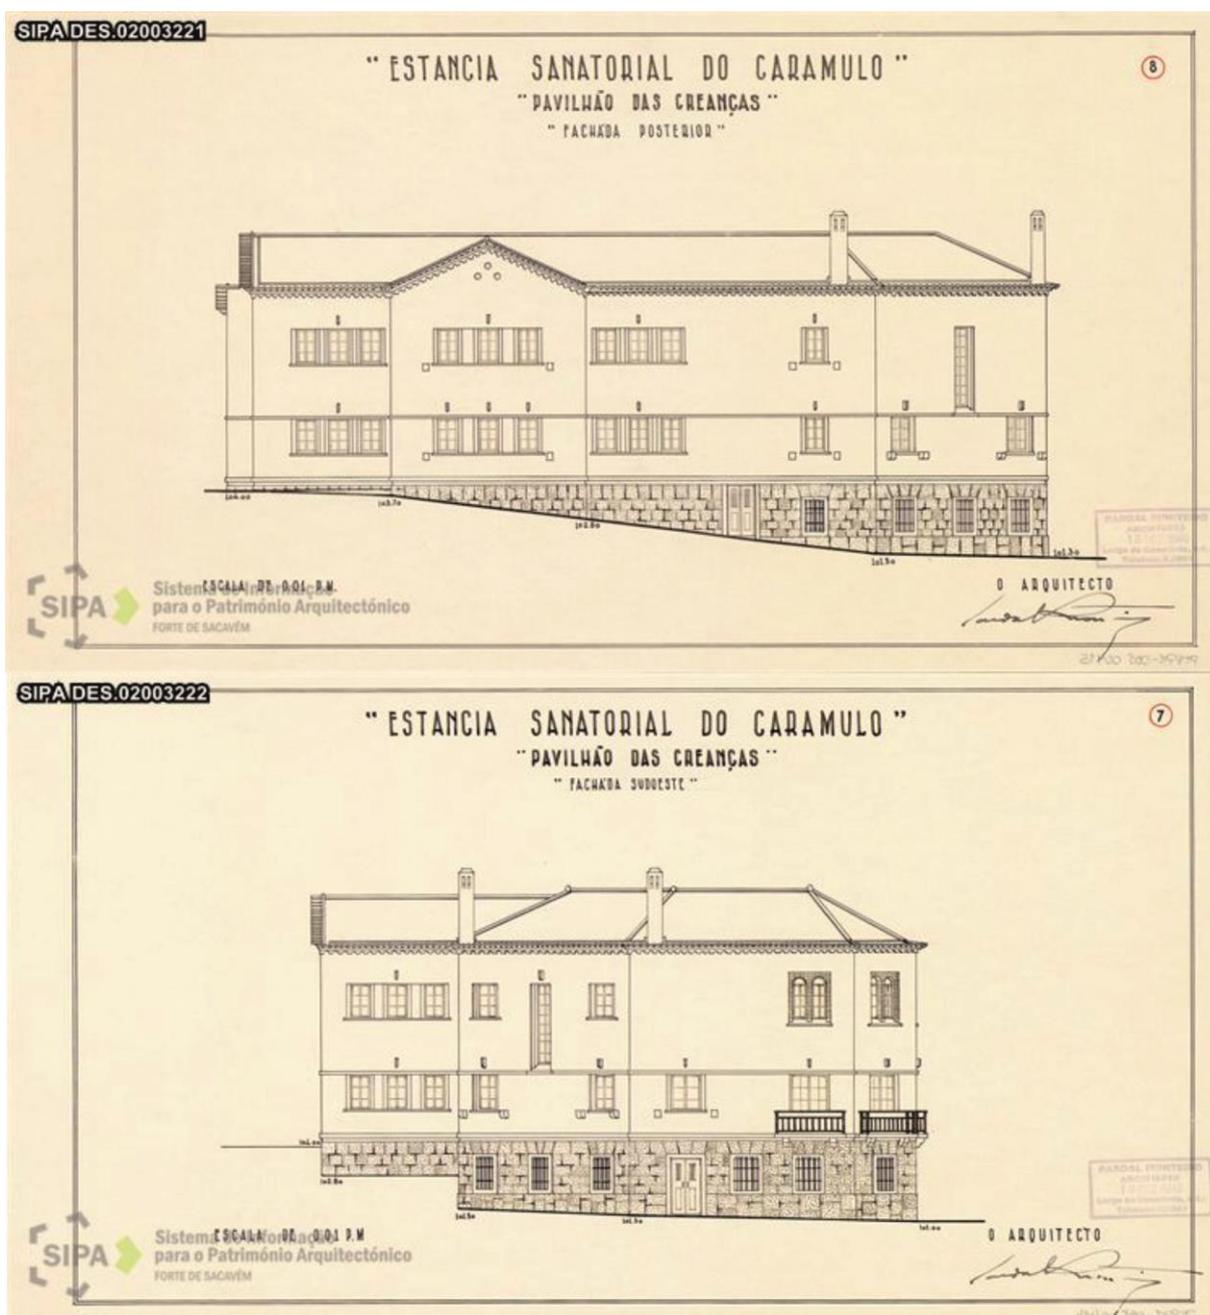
Fachadas Sudoeste e Posterior – projeto de Pardal Monteiro (fonte: SIPA)
